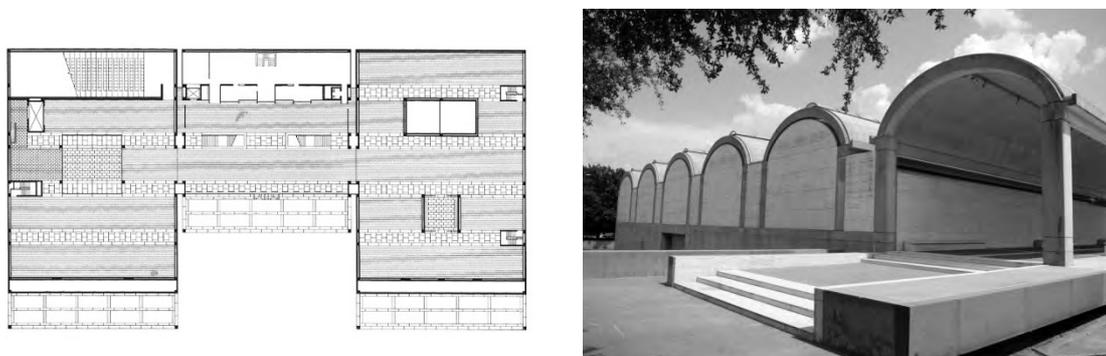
e 107 | Planta e vista externa Kimbell Museum [McCARTER]
